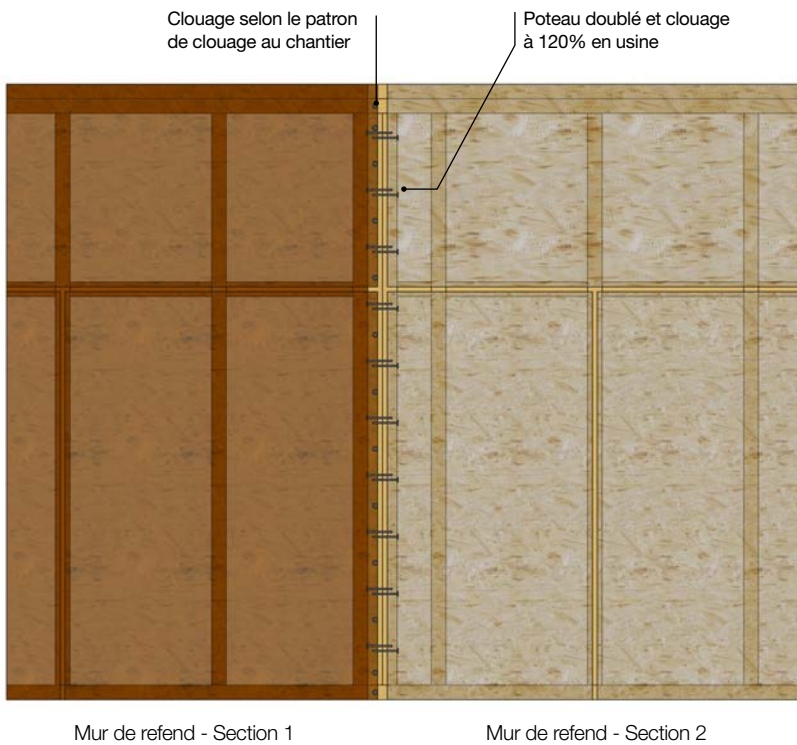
• Jonction entre deux murs de refend – Section de panneau au chantier – Élévation
